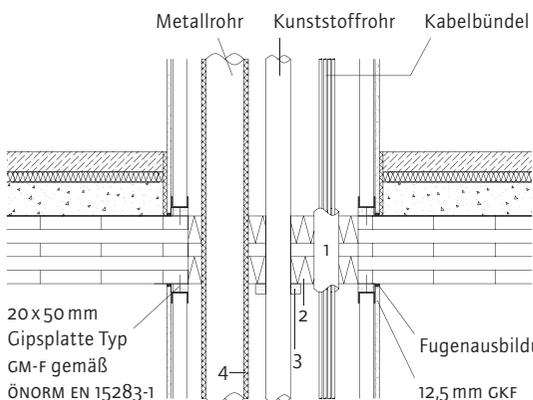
Beispielhafte Ausbildung einer horizontalen Abschottung im Bereich einer Massivholzdecke (Schachttyp B)
